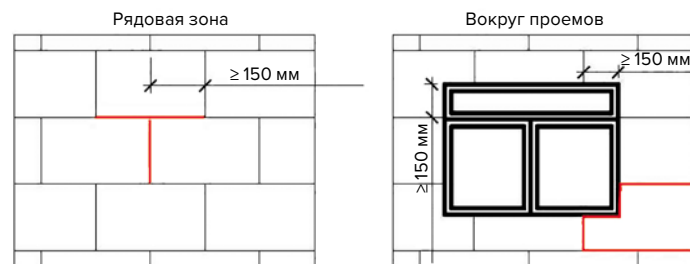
Схема установки плит на плоскости фасада и вокруг проемов
